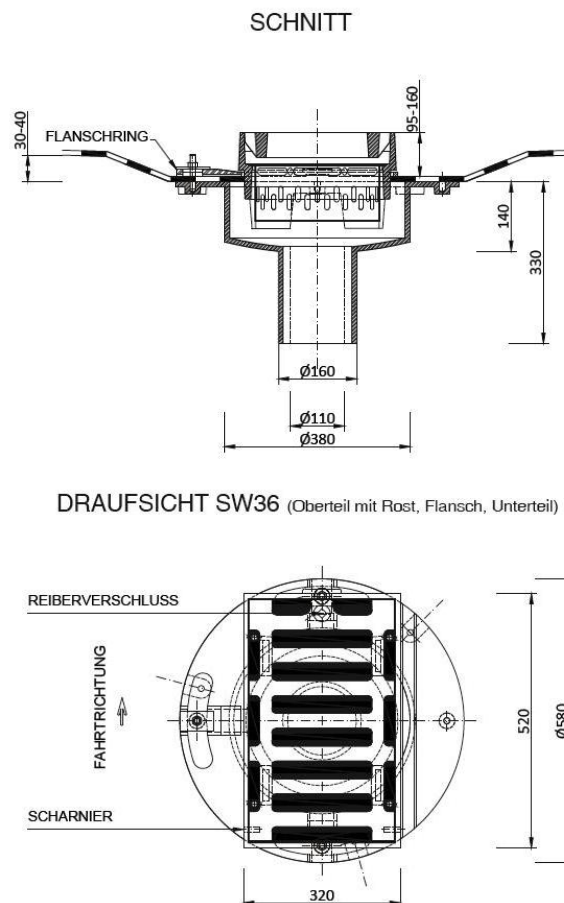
Geometrie des gewählten Aufsatzrahmens 2300/250-SW36 [34 S. 25]
